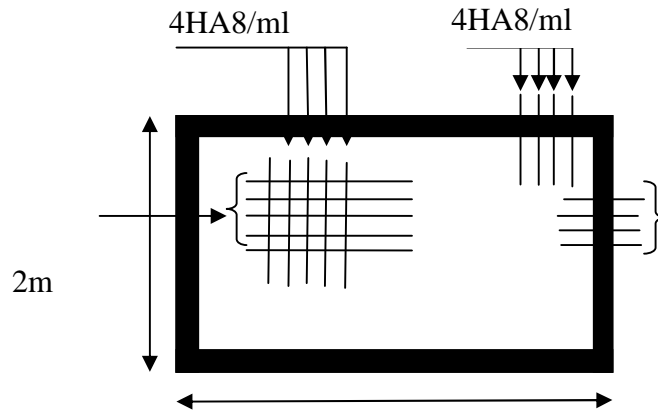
Schéma de ferrailage de la dalle sur 4 appuis panneau 2.
